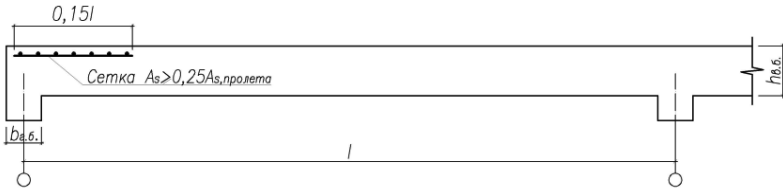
Схема армирования дополнительной сеткой над крайней опорой
